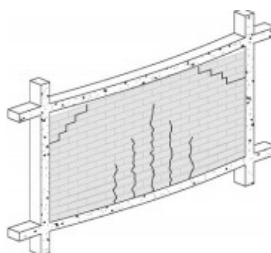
Fissuração de paredes divisórias causada pela deformação vertical da sua estrutura de suporte. Sousa e Sousa (2014)
